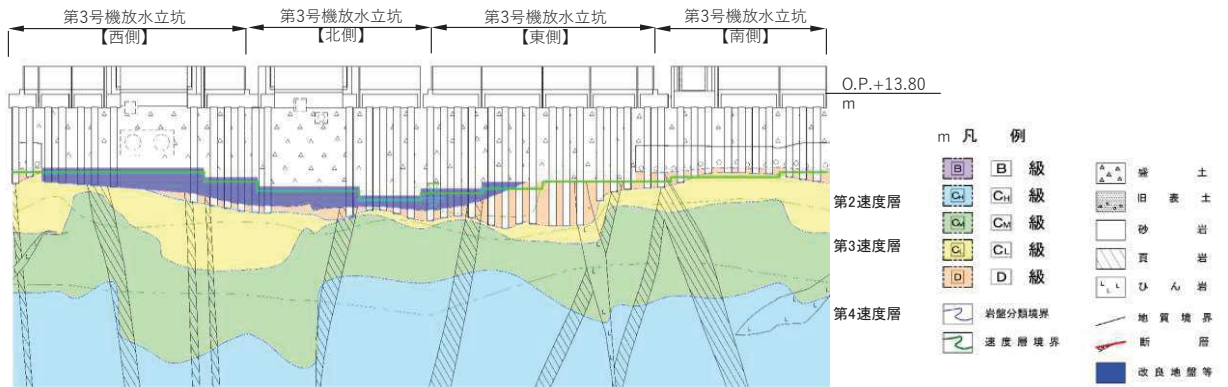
地盤改良体の配置図 (防潮壁 (第 3 号機放水立坑) , K-K 断面)
